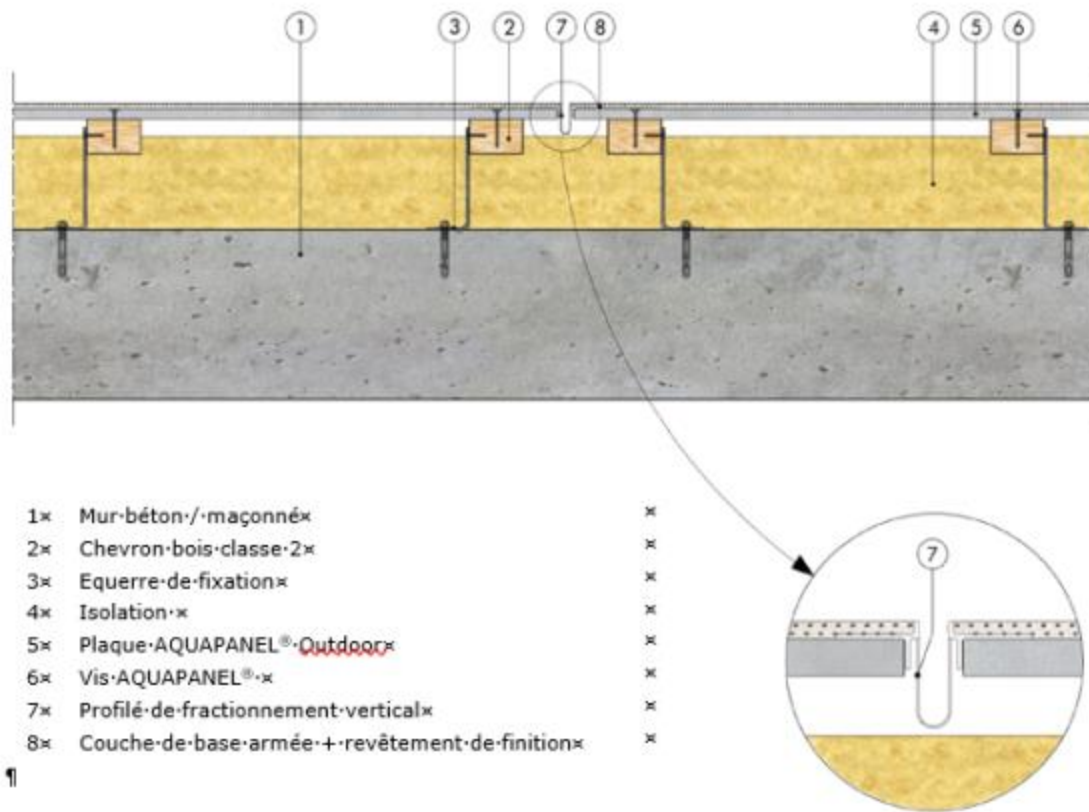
Joint de fractionnement vertical – Coupe verticale sur ossature bois
